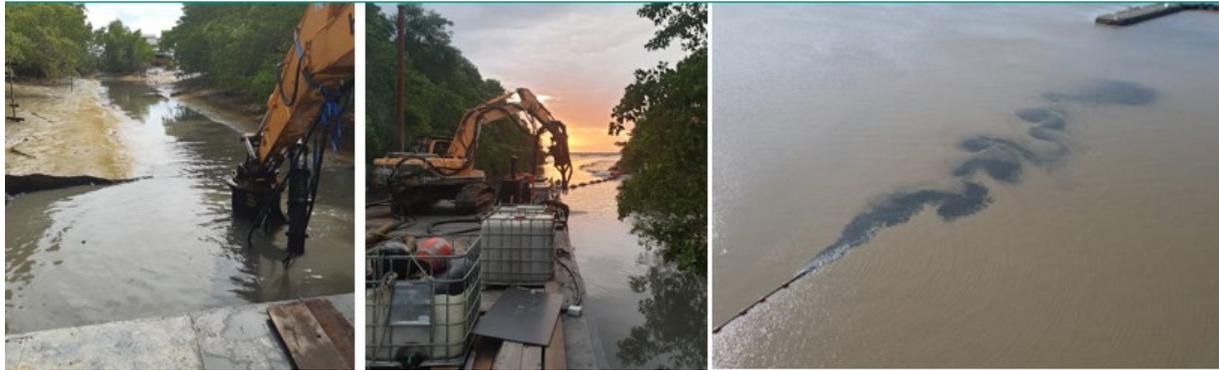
Dragage pas succion avec pipeline au niveau du canal Laussat (2020).
